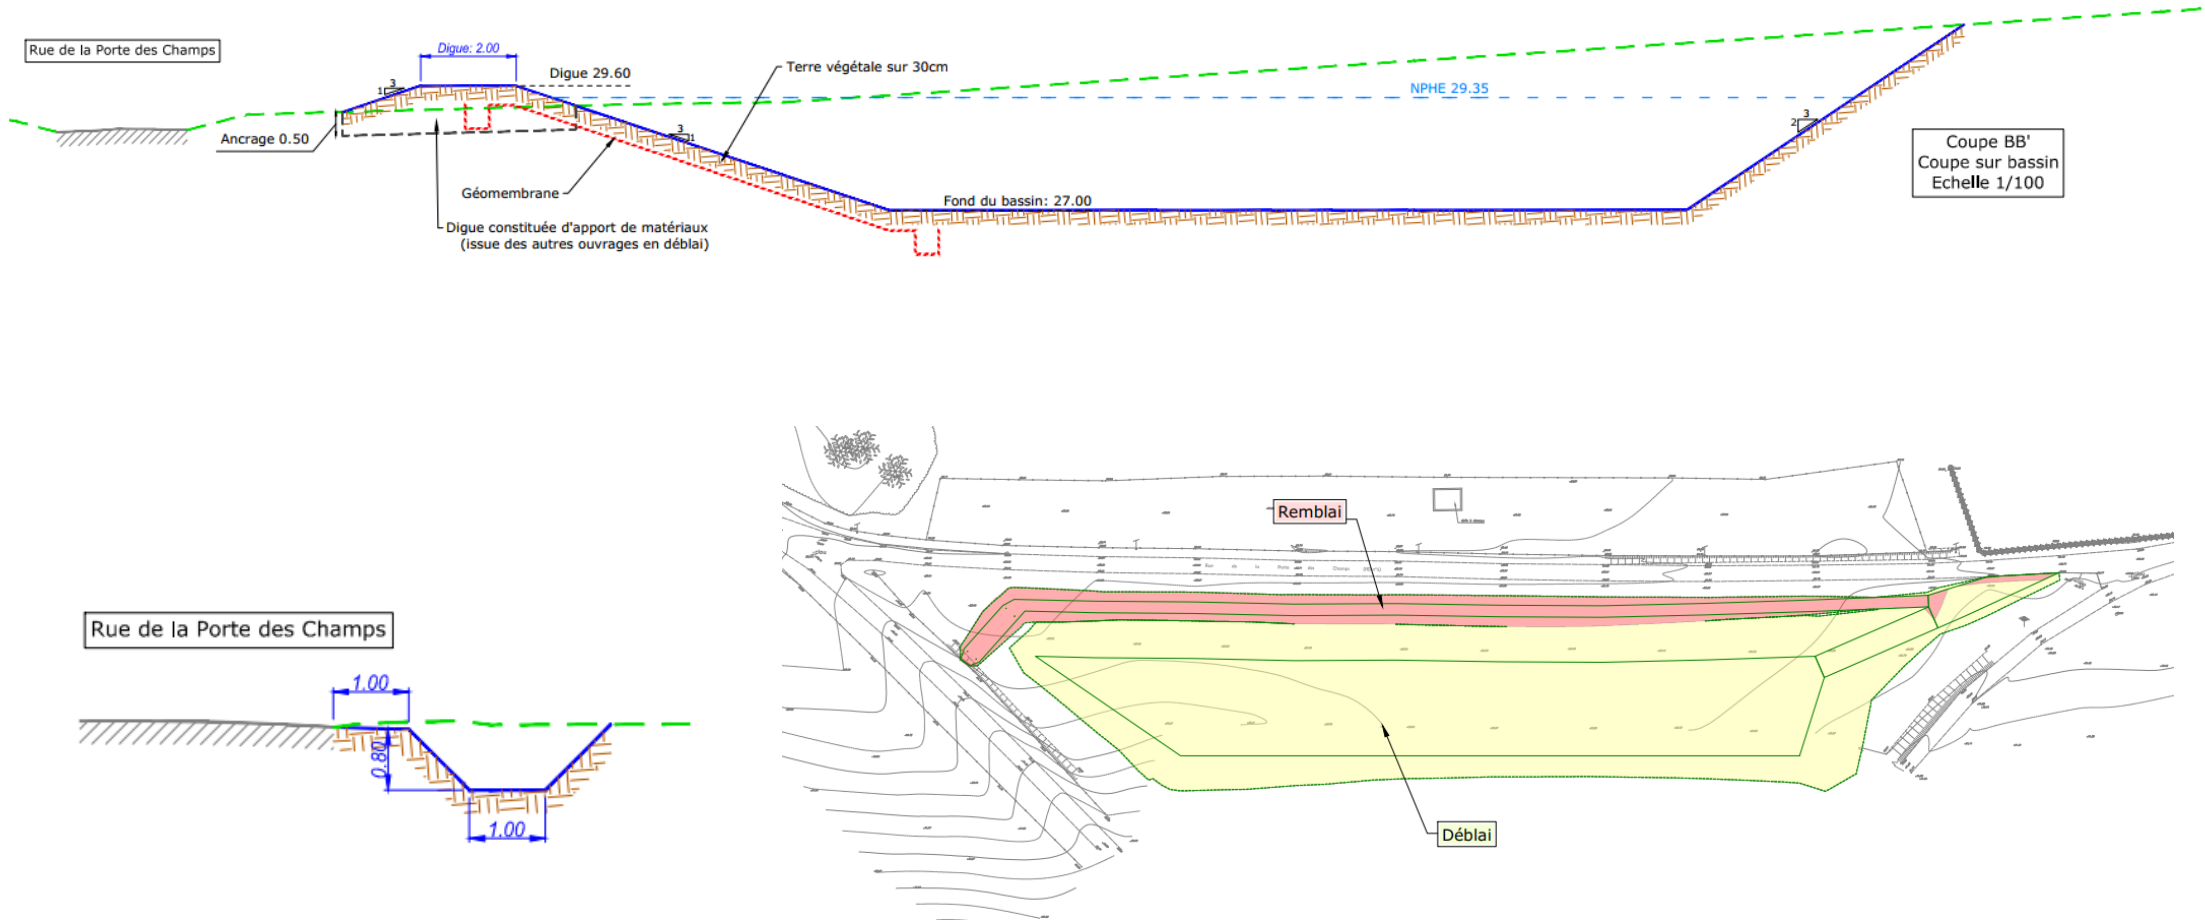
Coupes et plan des terrassements de l'ouvrage PD/B5
